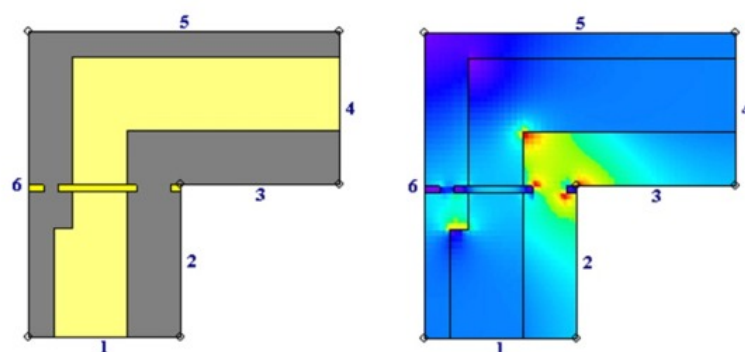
Konstruktion och värmeflöden för detaljen "Fönsteranslutning" i Lamellhuset - grundfallet. Figuren visar anslutningen mellan yttervägg och fönster. Fönstret är borttaget ur figuren och det är endast "störningen" i väggens utformning som studeras. Fönstrets inverkan på köldbryggan är inte medtagen.
